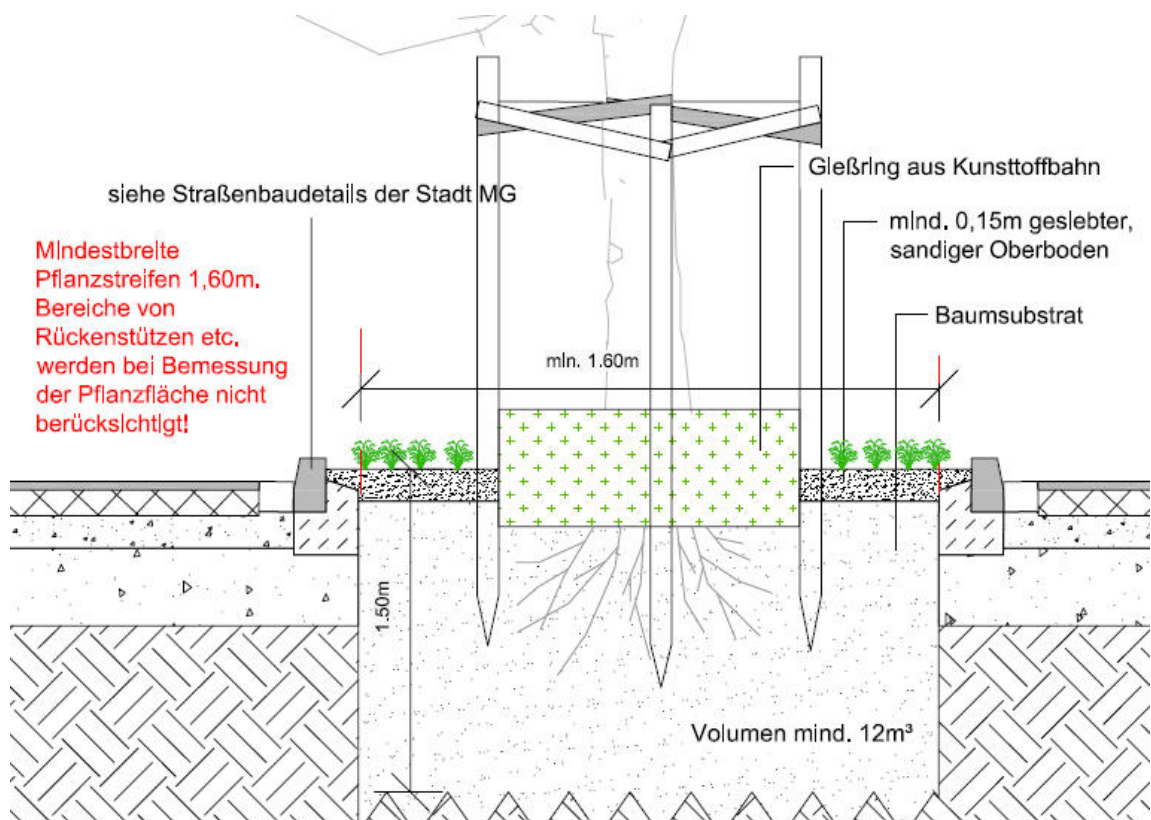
Großflächiges Straßenbegleitgrün mit Baum und Unterpflanzung
